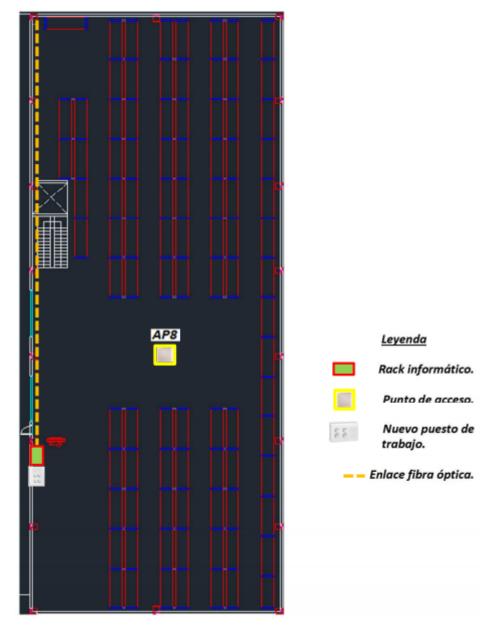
Plano de la zona EAG con la ubicación de los Access Point
